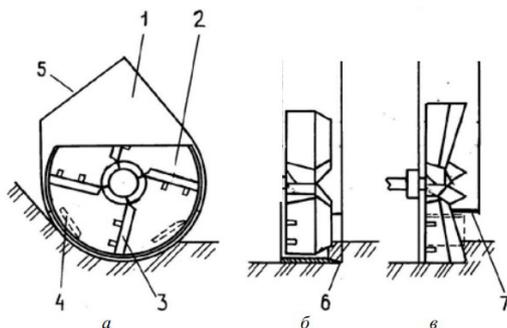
Схемы фрезерных рабочих органов с осью вращения, параллельной оси канала: а — вид спереди; б — вид сбоку фрезы с кожухом, опирающимся о дно; в — вид сбоку фрезы с кожухом, не опирающимся о дно; 1 — кожух; 2 — диск; 3 — ножи-лопатки; 4 — дополнительные ножи; 5 — выбросное окно; 6 — режущая кромка; 7 — противорежущая кромка
